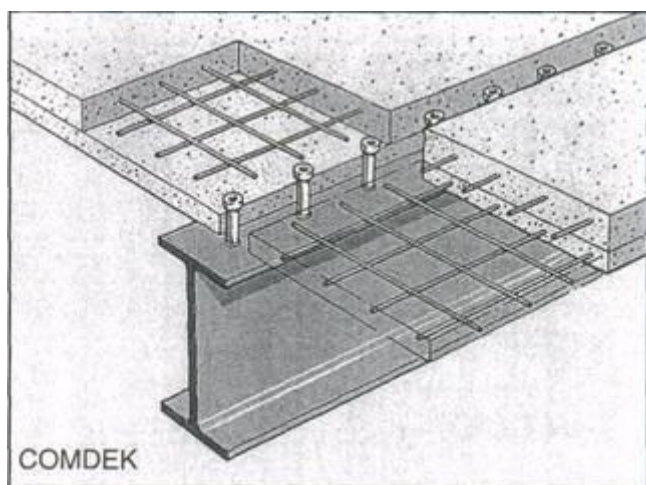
Варіант сталезалізобетонного перекриття системи «Comdek»
